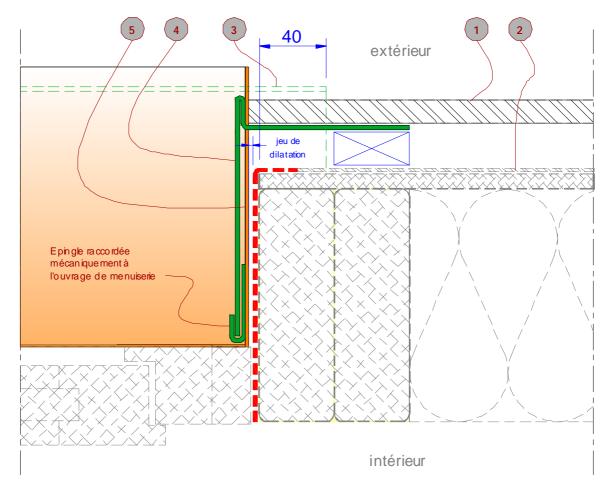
Pose sur COB – Coupe sur appui de baie Dispositions particulières du traitement des baies (Menuiserie en tunnel intérieur)
